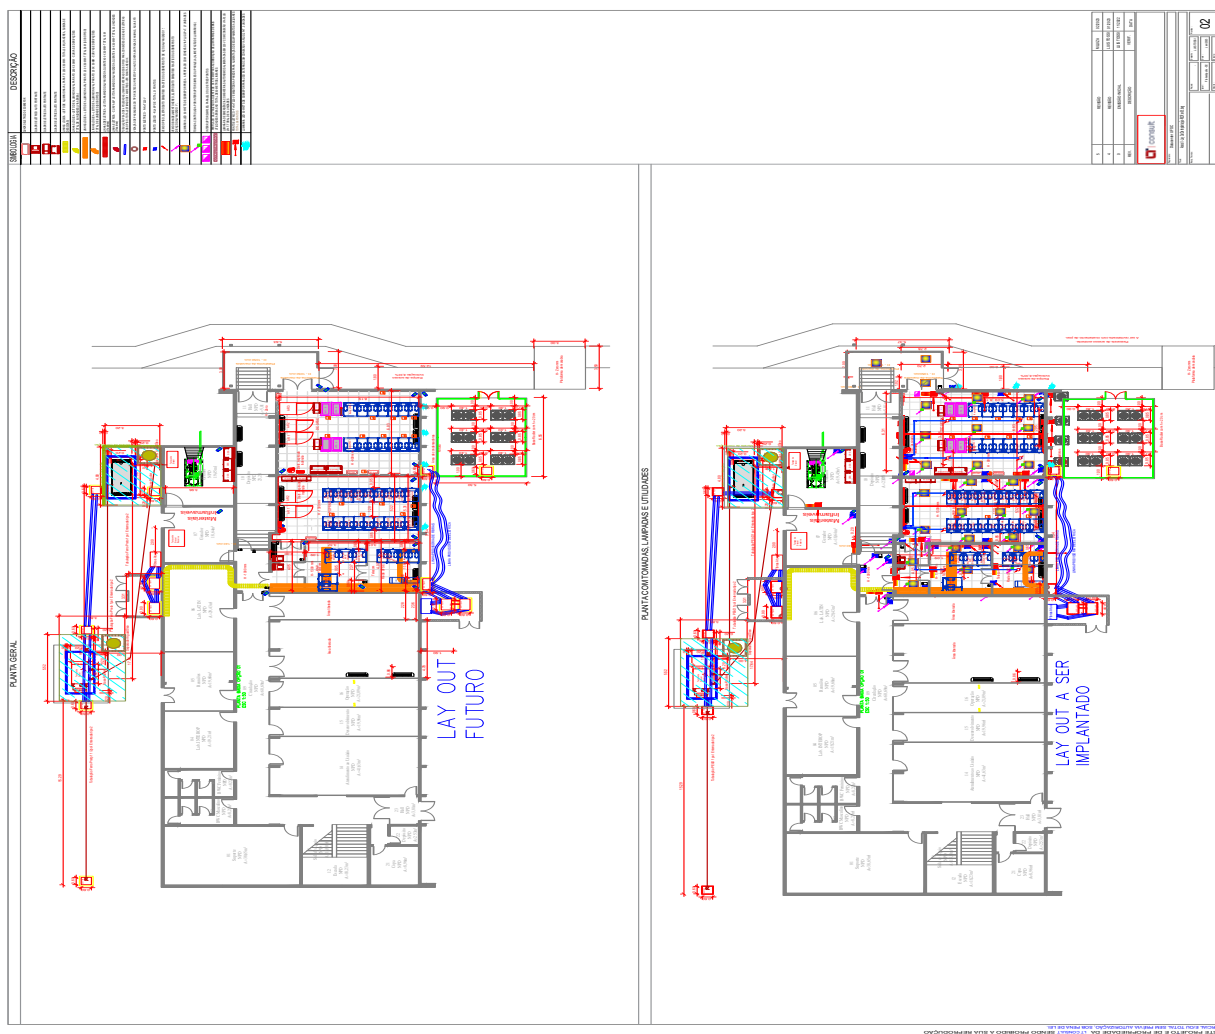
Anexo II - Layout de implantação-R02 rev 05-CIV-02
